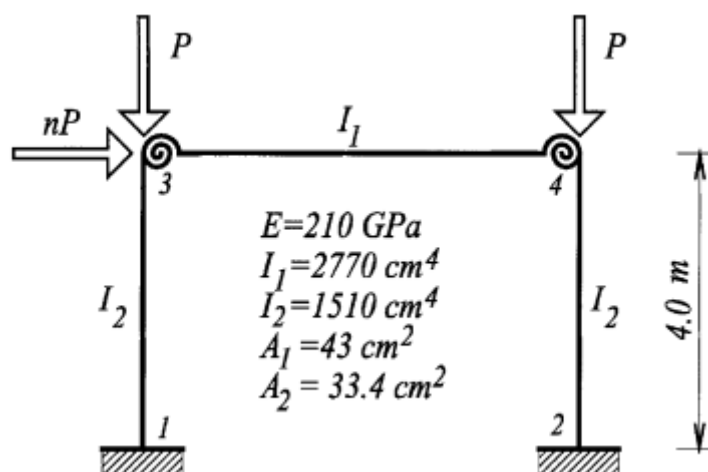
Pórtico plano com ligações semirrígidas (Fonte: Sekulovic, 2001).
